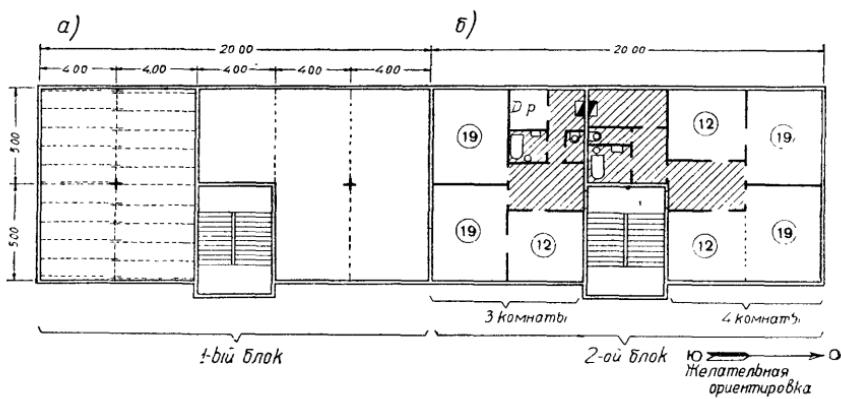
Схема планировки трех- и четырехкомнатных квартир с расположением лестниц и хозгрупп по разным фасадам; хозгруппа около входа (а — схема опор и перекрытий; б — схема планировки)
